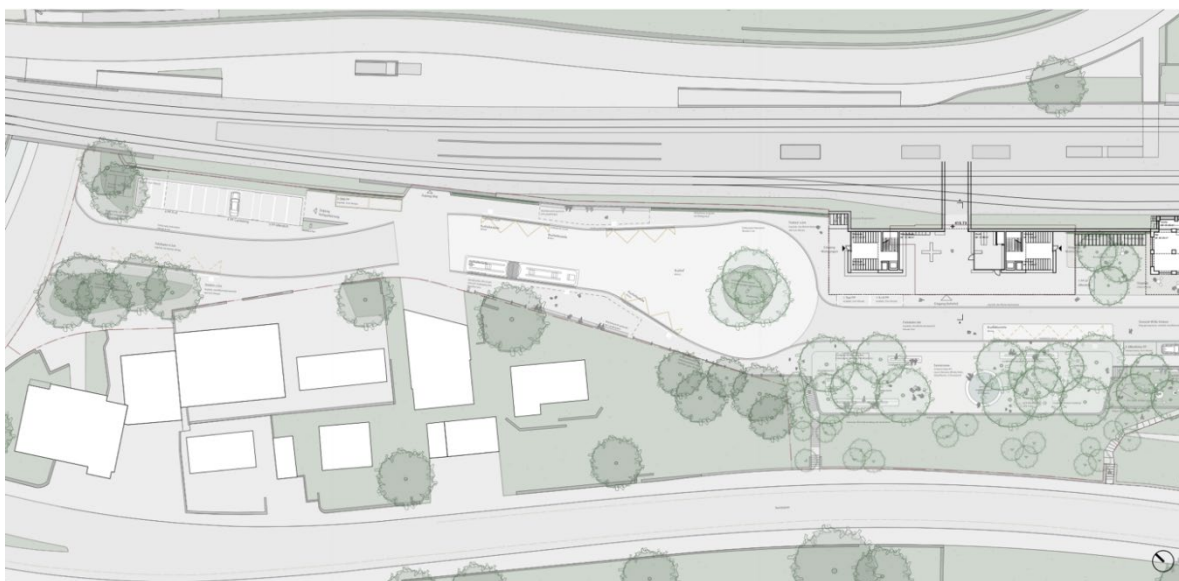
Situationsplan Bushof mit Wendeschleife – Grundriss Stand Oktober 2024
